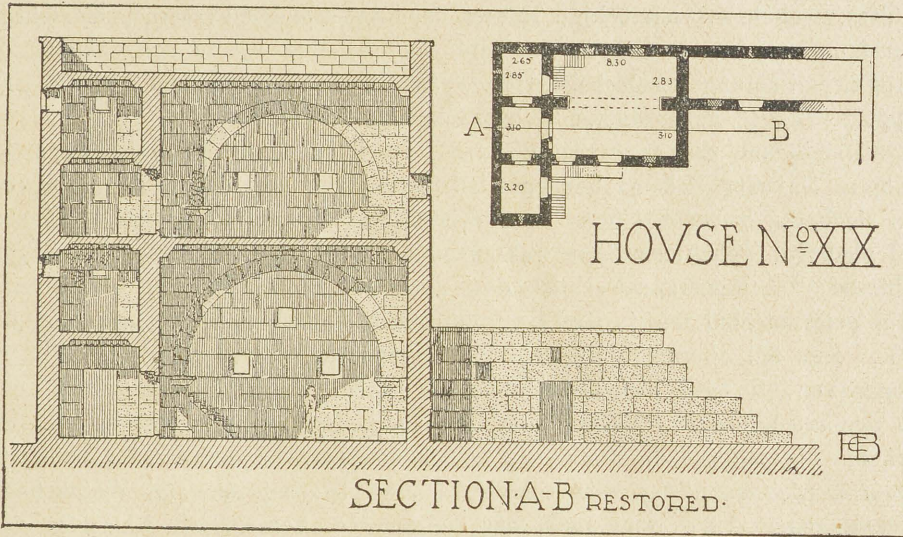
Haus in Umm id-Dschimal. Maßstab 1 : 500 (Grundriss) und 1 : 250 (Aufriss).
